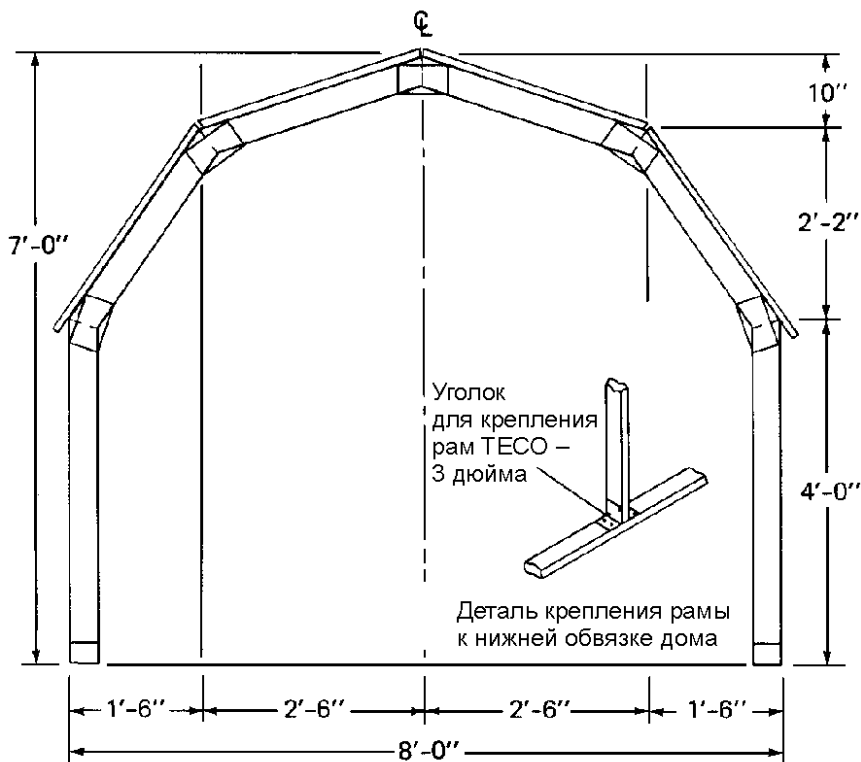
Разметка конструкции легкой рамной крыши (ТЕСО)
